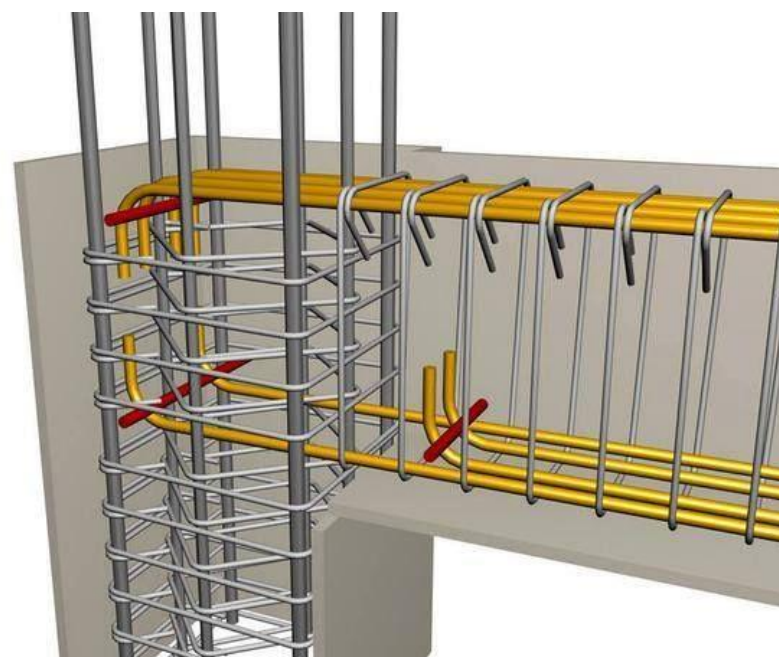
Columna viga detalle. Tomado de Civil Engineers anclaje detalle.
